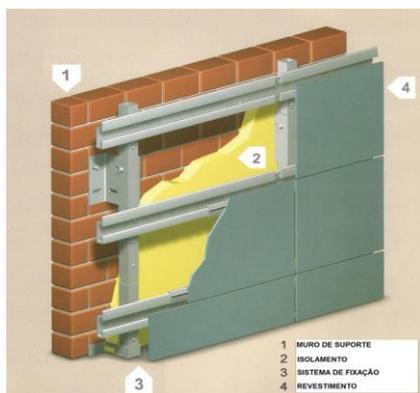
Representação de um sistema de fachada ventilada. Fonte: [18].
